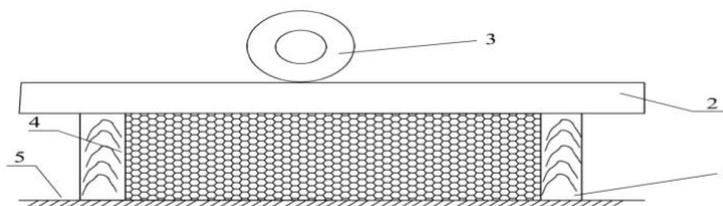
Схема уплотнения бетона на захватке с помощью виброрейки:
